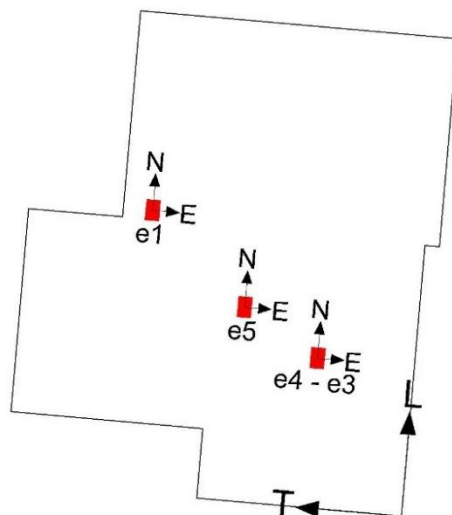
Vista en planta del edificio N°1. Ubicación, orientación y numeración de equipos utilizados
